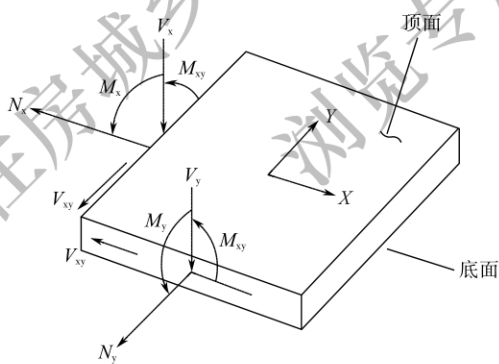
在平面内剪力、轴力、平面外弯矩共同作用下的单位宽度钢板混凝土剪力墙单元
